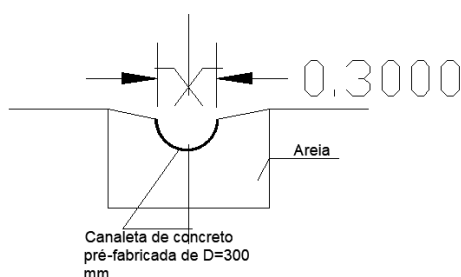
Seção tipo da canaleta de drenagem provisória. Diâmetro igual a 300 mm.
